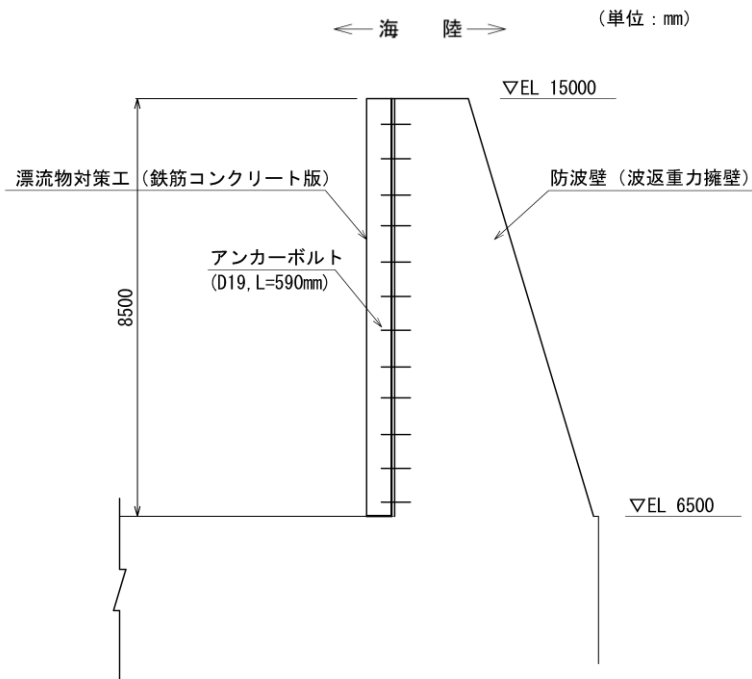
(2) 防波壁 (波返重力擁壁) 重力擁壁における漂流物対策工 (鉄筋コンクリート版) のアンカーボルト配置図 (断面図)
